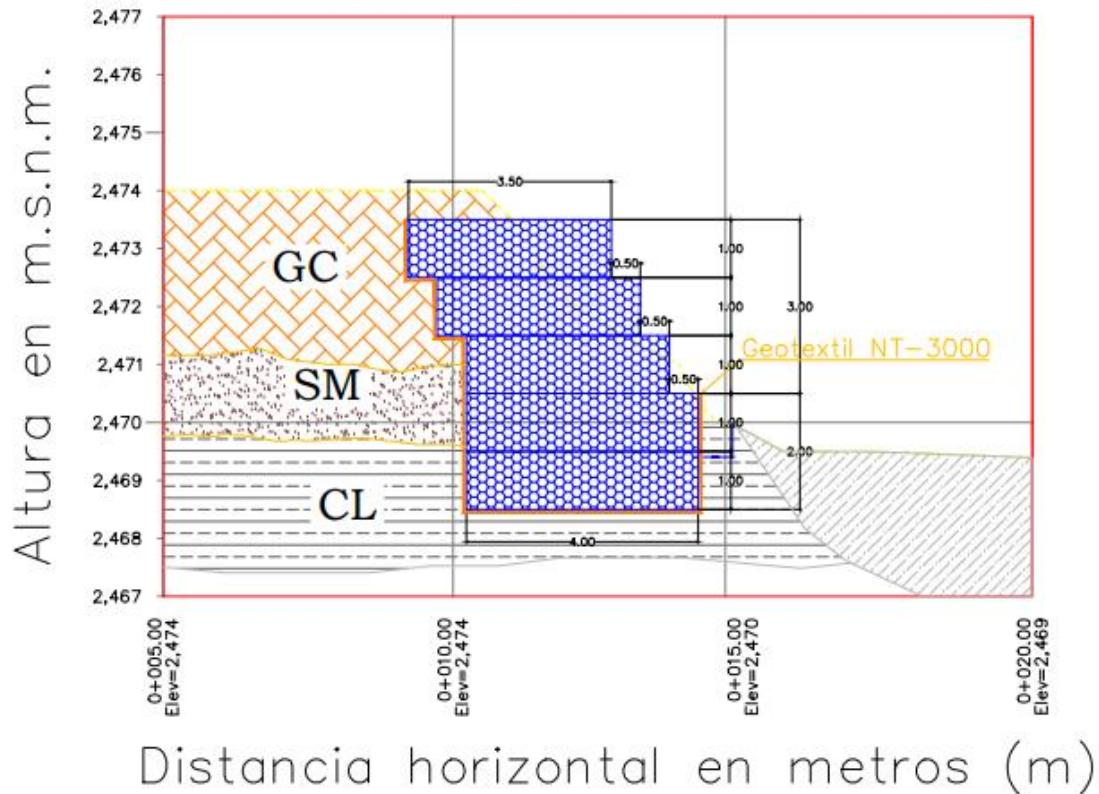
Perfil transversal 8, con muro gavión implantado.
